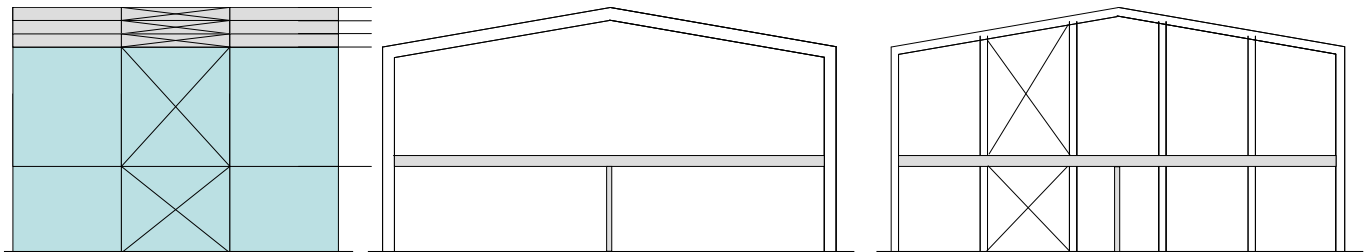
Bâtiment en charpente acier avec plancher intermédiaire, contreventement par palées de stabilité en façades et pignons, contreventements par portique en travées transversales courantes – nécessité de stabiliser le niveau de plancher et le niveau de toiture.
